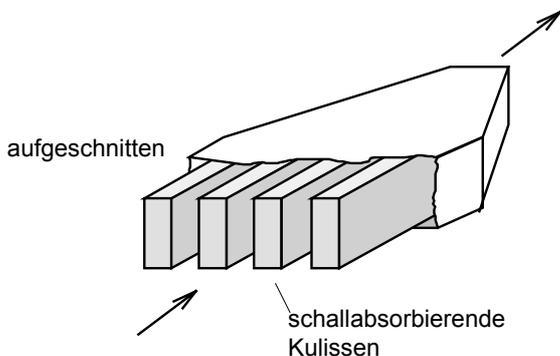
Kulissenschalldämpfer (einseitig aufgeschnitten)
